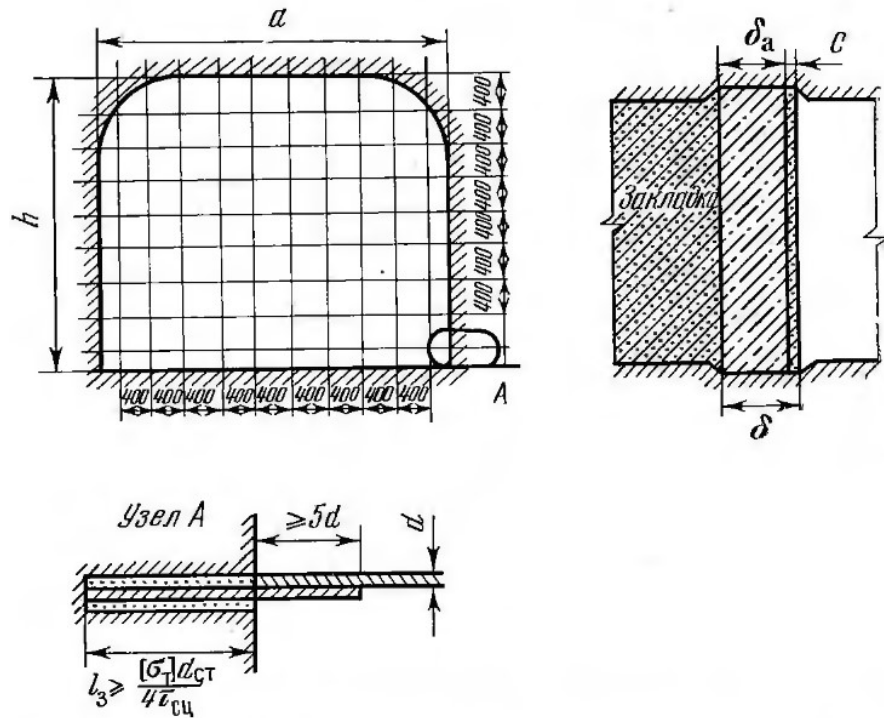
Конструкция железобетонной перемычки, защемленной по контуру [5]
